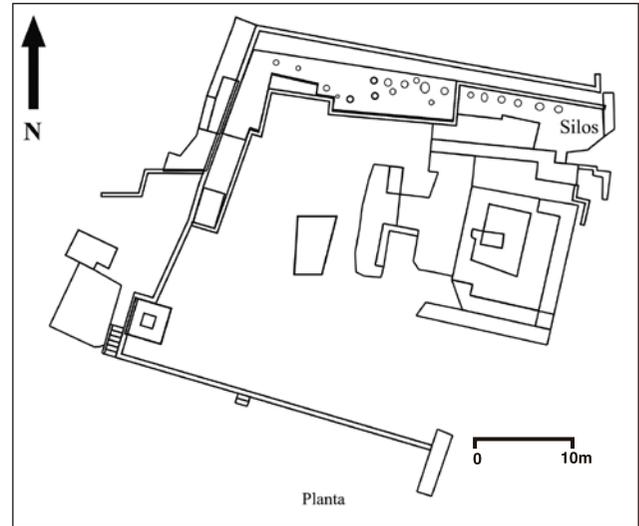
Planta unidad 207, plataforma donde se ubican los silos. Fuente: Proyecto Especial Cantona.
